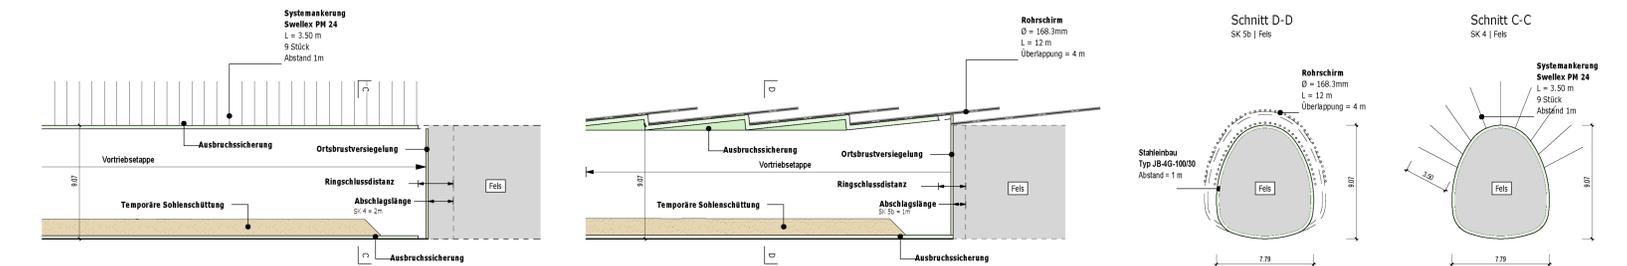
Bau- und Betriebsweise der Felsstrecke
